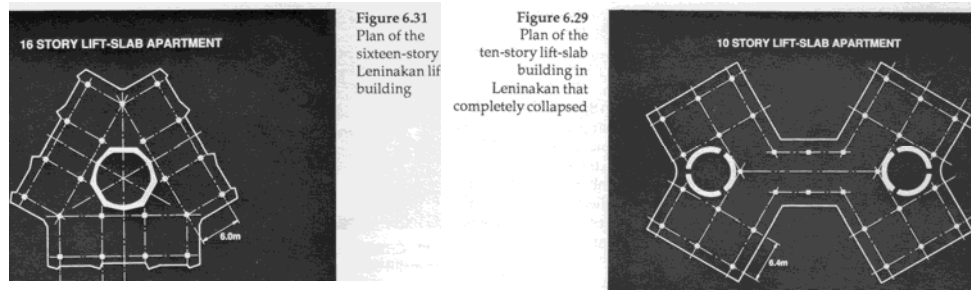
典型的なリフトスラブの平面図(ref.1)
